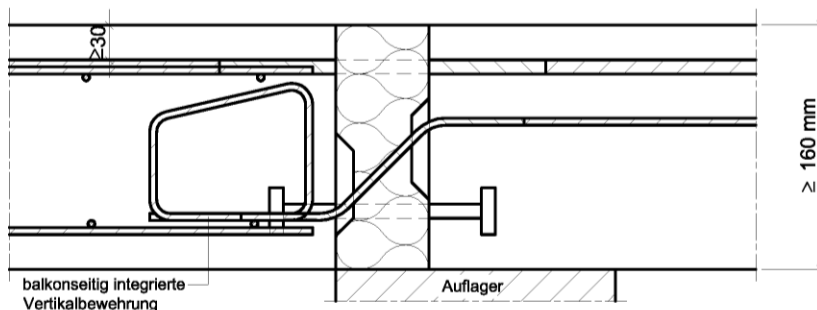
Beispiel Schöck Isokorb® Typ KX
